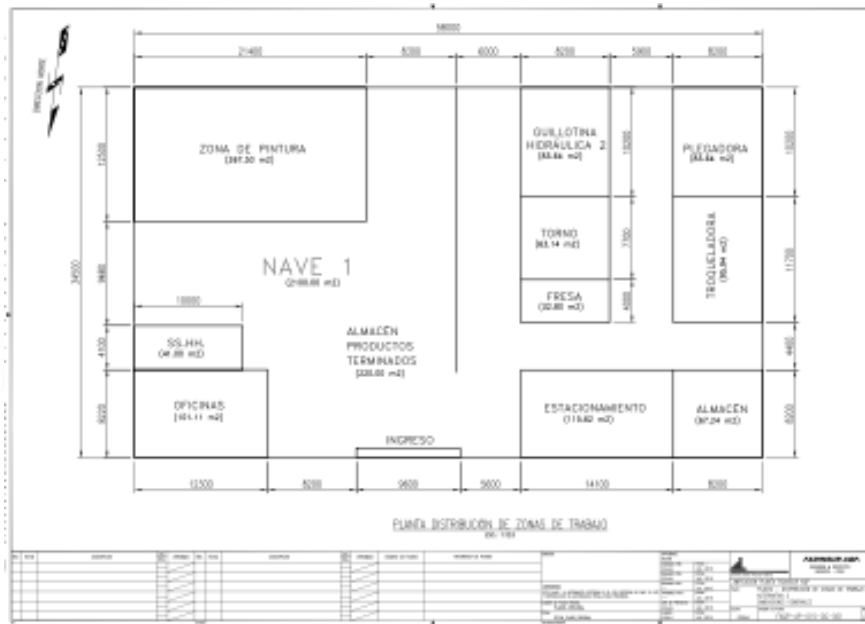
Distribución actual de planta de la empresa FADIMSUR AQP
